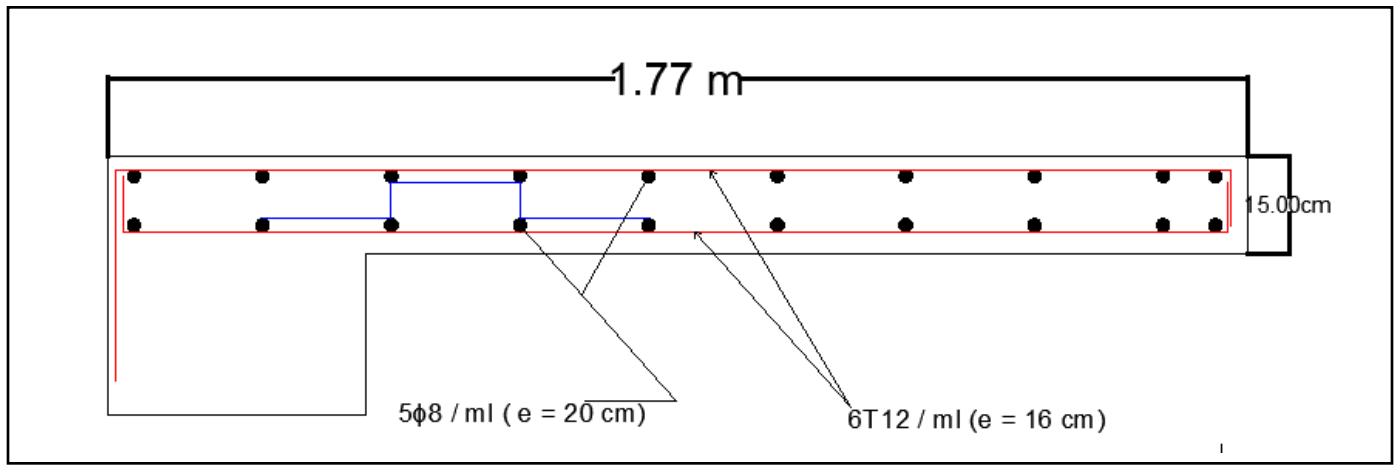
Schéma de ferrailage de l'balcon (par autocad)
